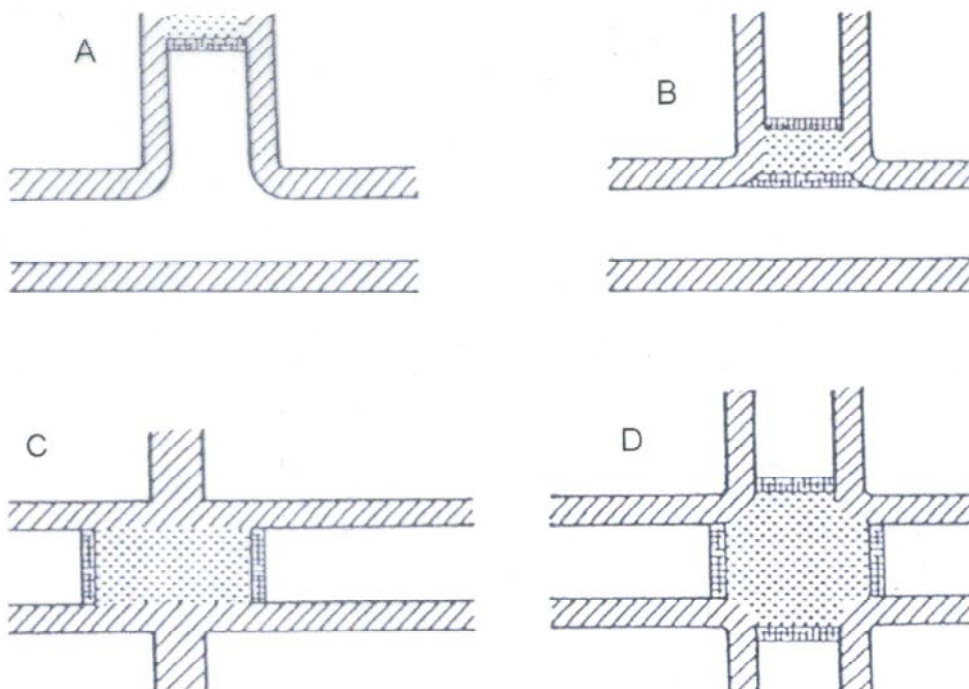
A: sopraelevazione che precede la sezione di sbocco; B: sopraelevazione nella sezione di sbocco con passaggio allo stesso livello del marciapiede; C: sopraelevazione lungo il tronco stradale; D: sopraelevazione dell'intera area d'intersezione.
